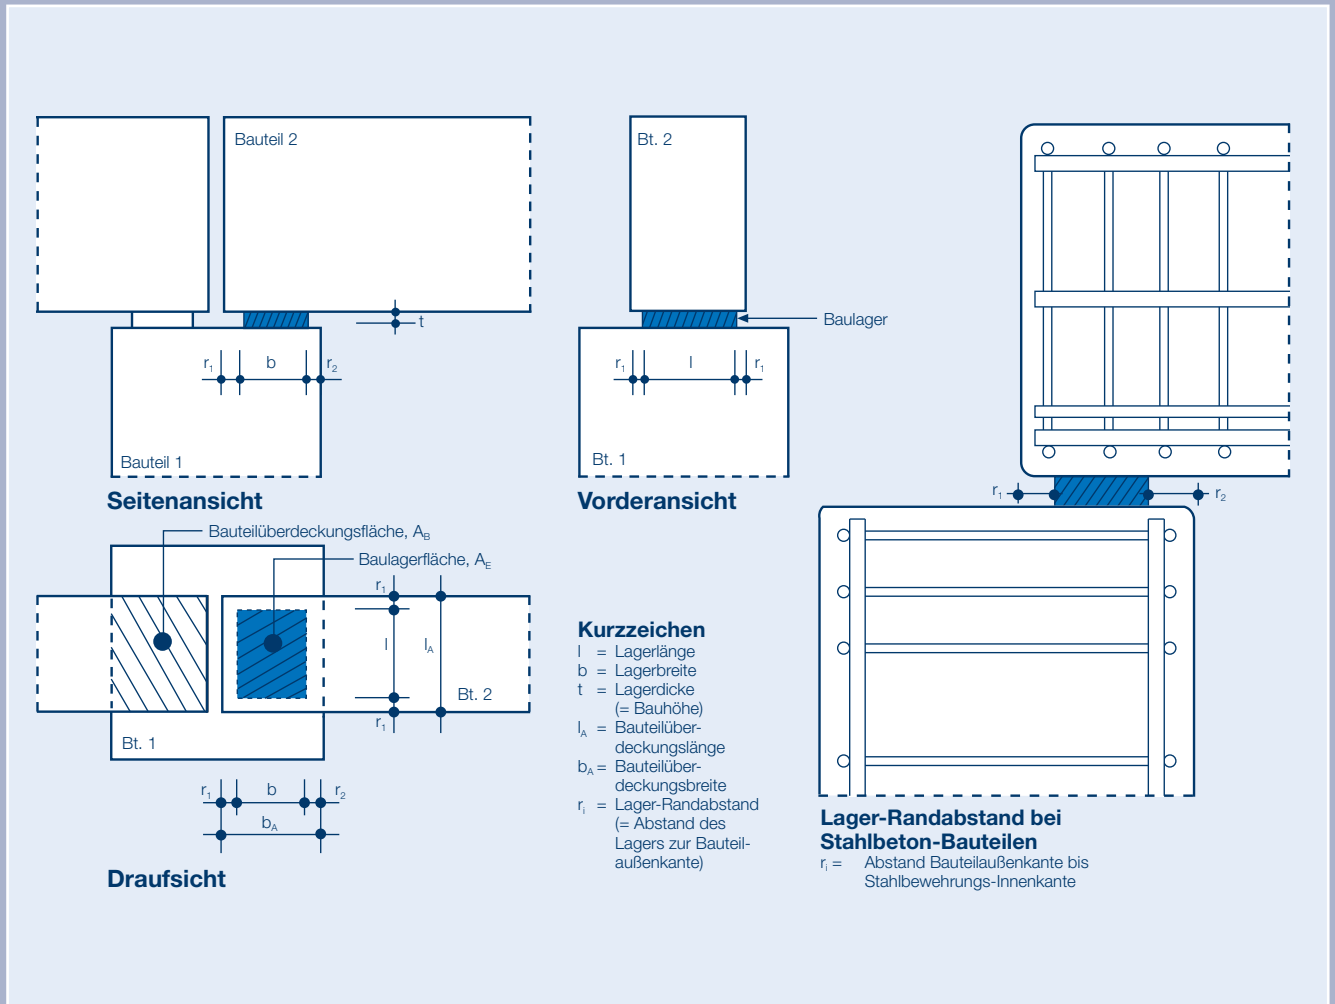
Maximale Größe der Grundrissfläche eines Elastomerlagers im Stahlbetonbau (Randabstand). Bei Bauteilen aus Holz oder Stahl sollte der Randabstand des Elastomerlagers mindestens 3 cm bzw. den 1,5-fachen Wert der Lagerdicke haben.
